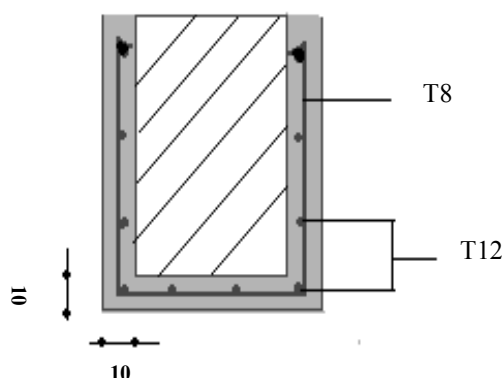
Coupe dans la (poutre / poutrelle) qui identifie les exigences de Chemisage
